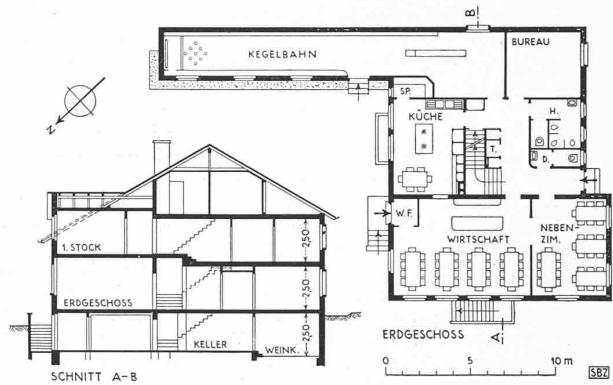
Wirtshaus Nägelsee, Grundriss und Schnitt 1 : 400
